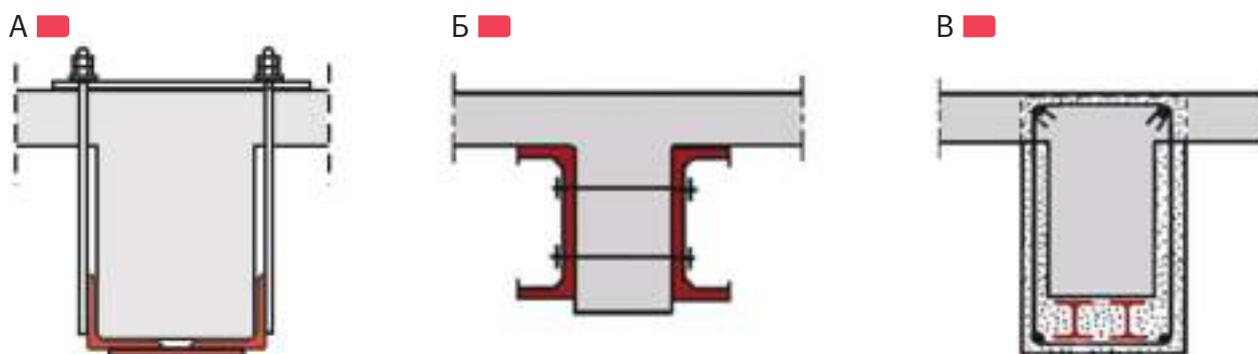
Схема усиления железобетонных балок увеличением сечения: А – с совместной работой за счет обжатия и трения; Б – накладными элементами со стягиванием шпильками; В – преобразованием элемента в сталежелезобетонный
